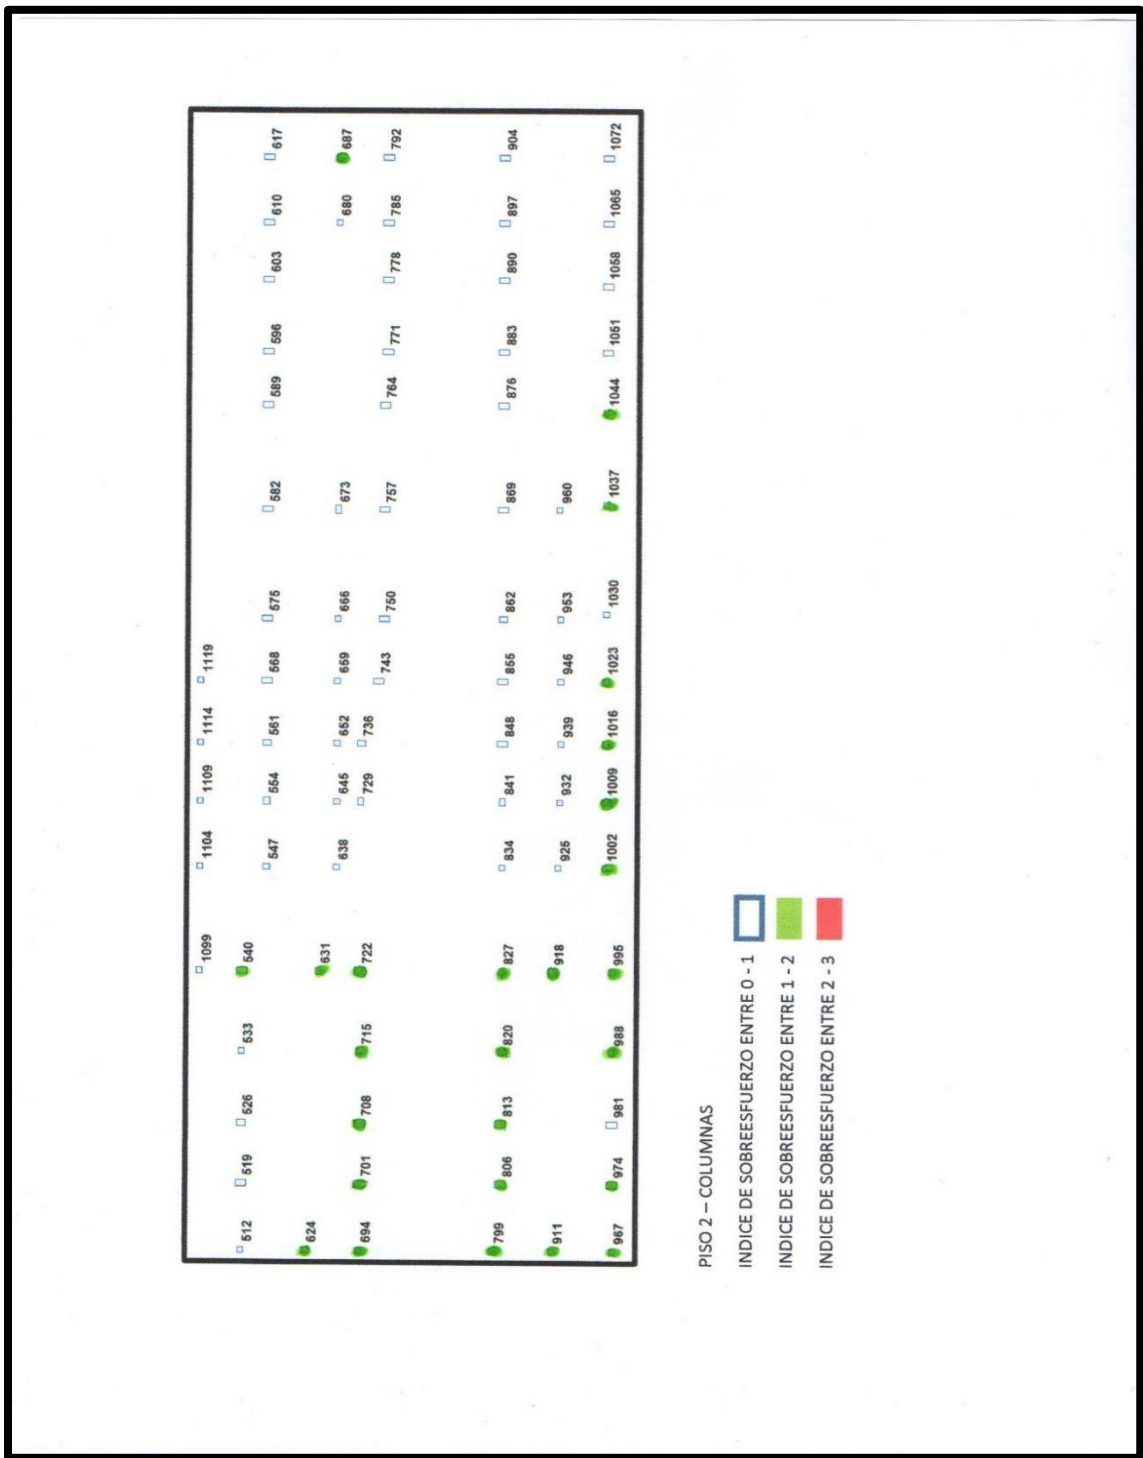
Sobre esfuerzos de columnas piso 2. Fuente: Los autores
